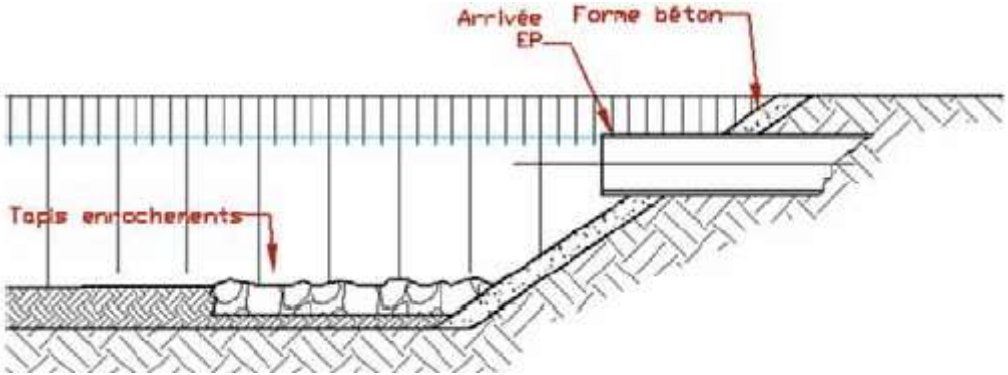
Ouvrage d'amenée des eaux dans le bassin – coupe type
